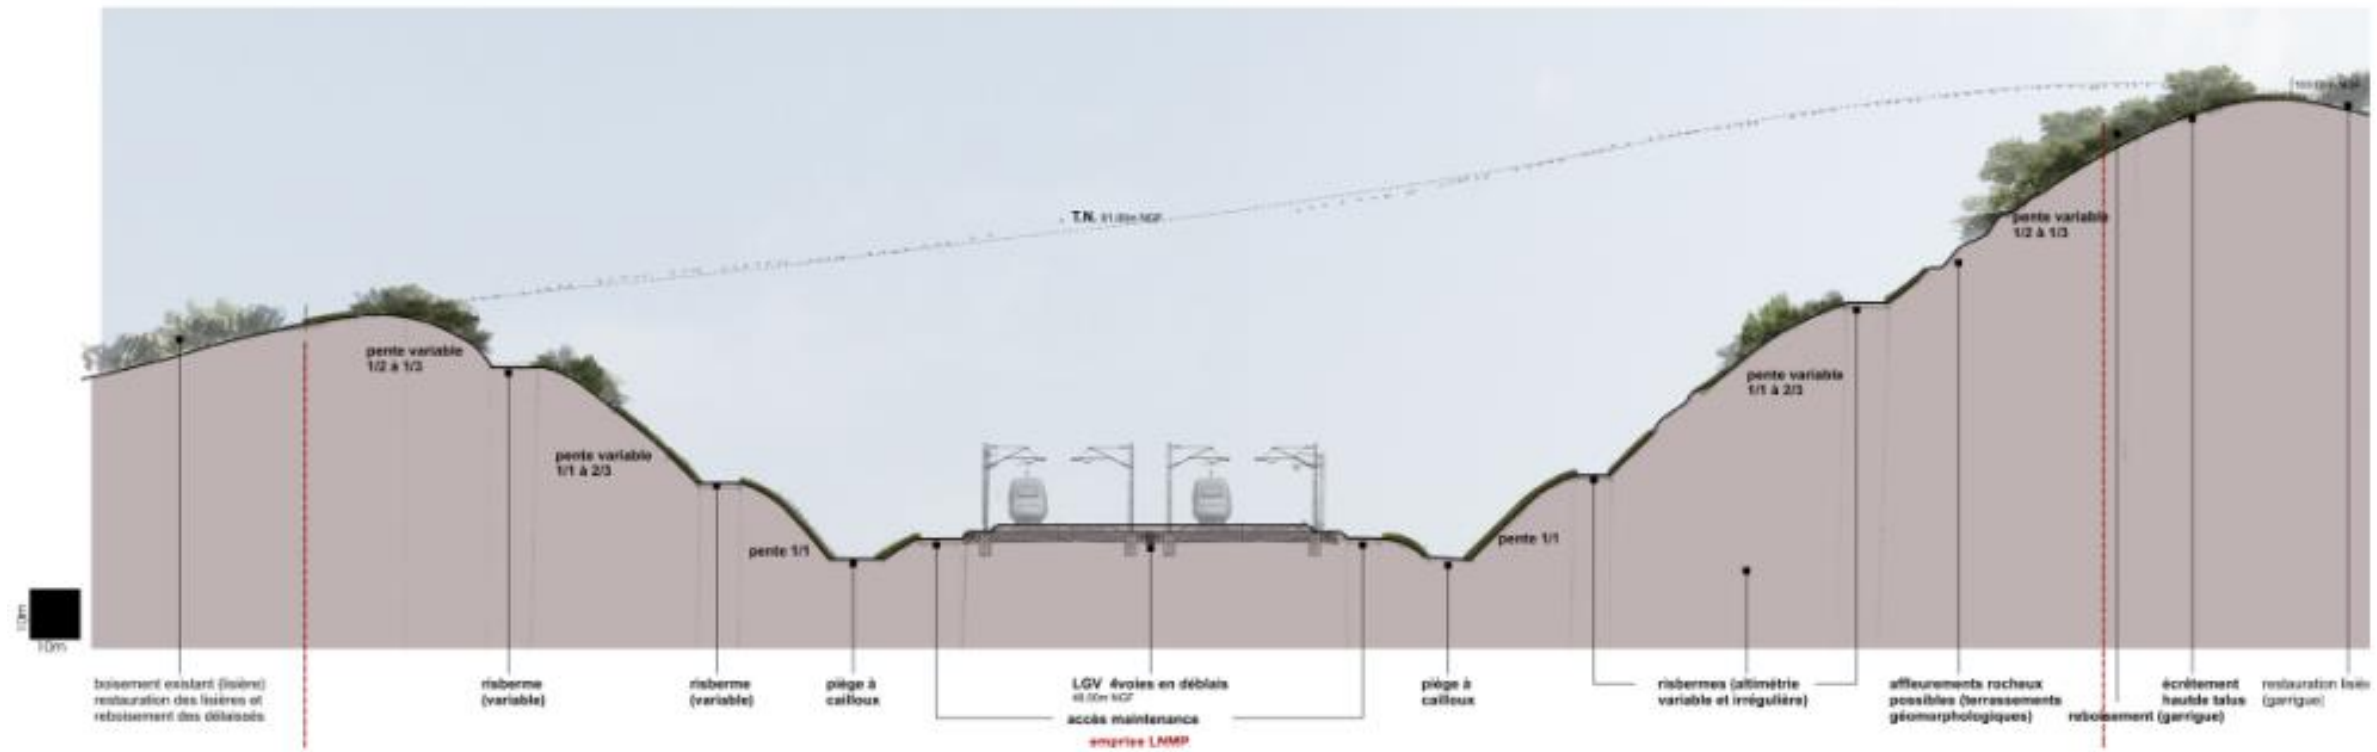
profil particulier / coupe AA sur la Métairie Haute (source : Traverses)
